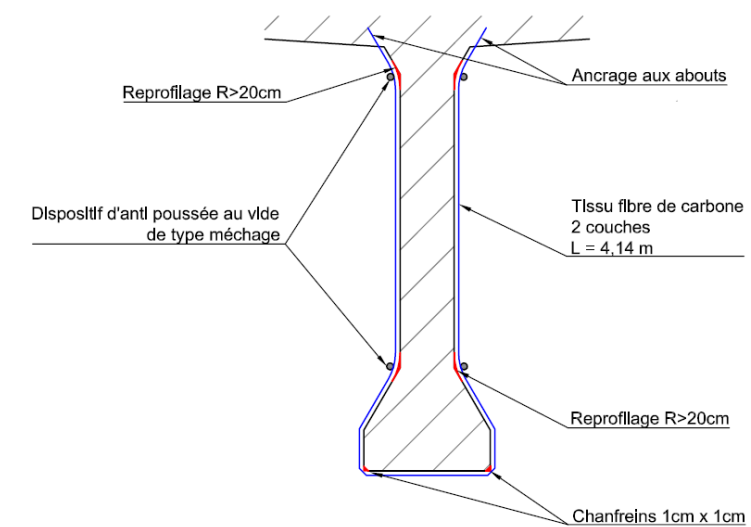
Schématisation de la pose de plat carbone au niveau des poutres de l'ouvrage (Source : DIADES)
